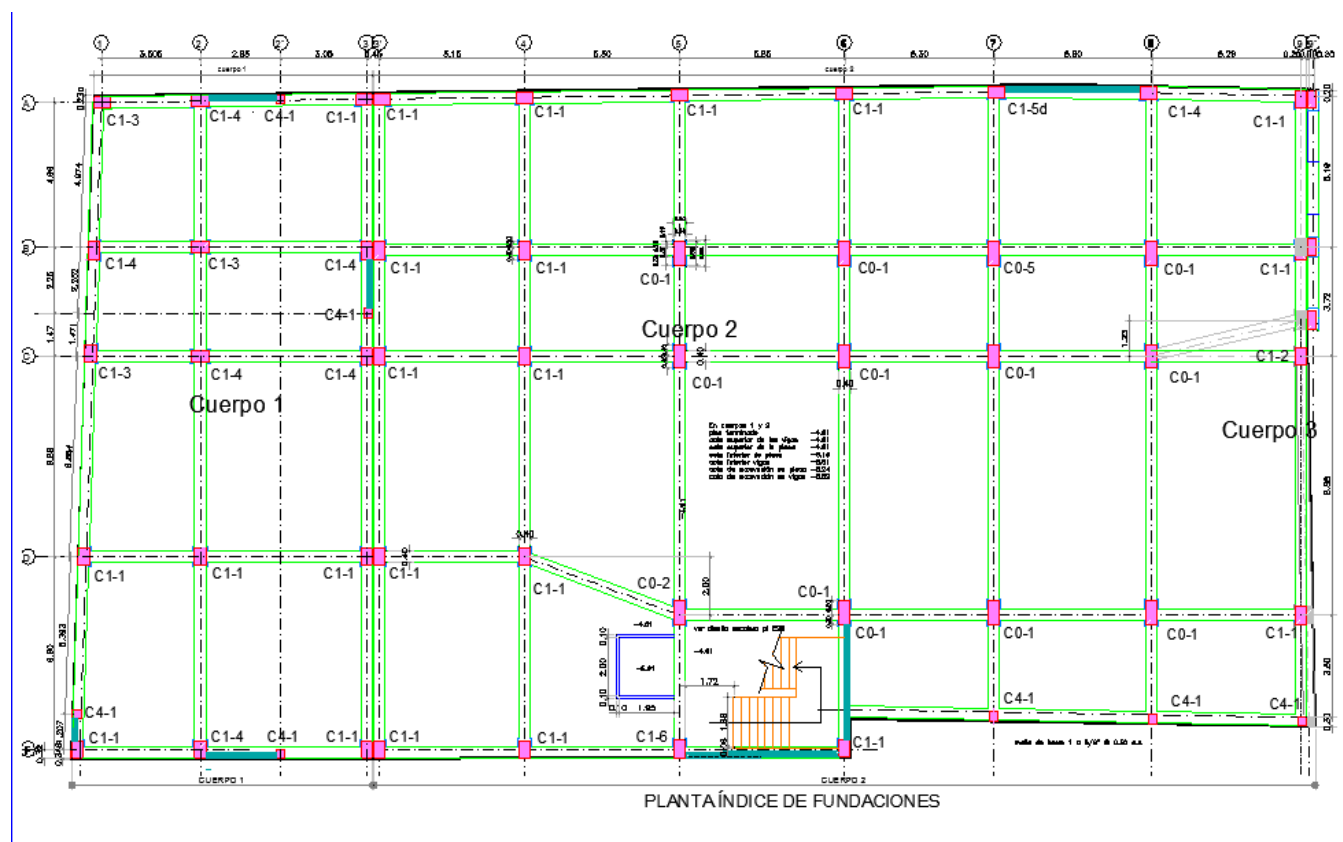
Vista en planta de vigas de cimentación, arranques de columnas y pantallas, cuerpo 1, cuerpo 2 y cuerpo 3.
